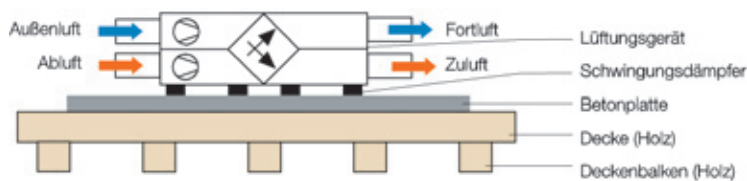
Schallentkoppelte Aufstellung auf einer Holzbalkendecke
